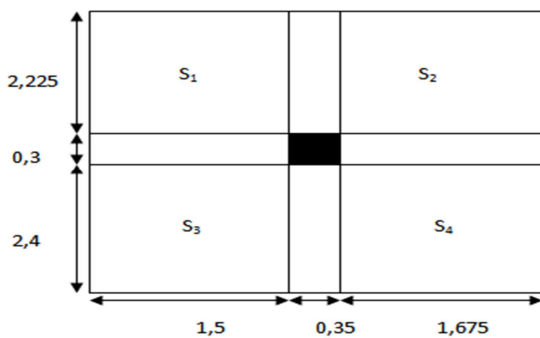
surface du plancher et celle de la toiture revenant au poteau C4.
